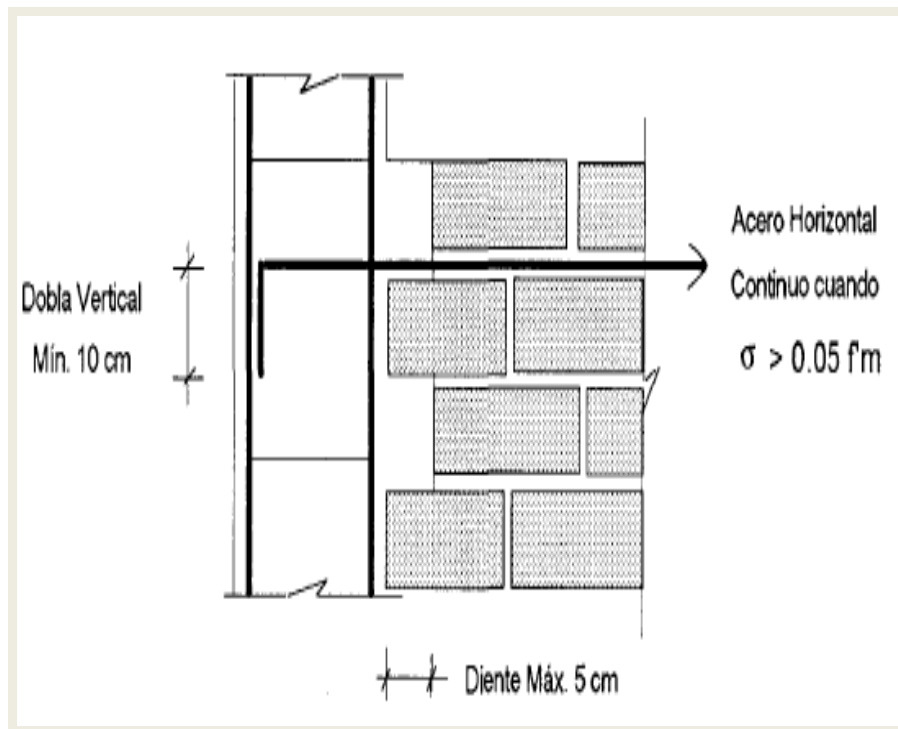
Detalle del anclaje del refuerzo horizontal continuo en un muro confinado.
